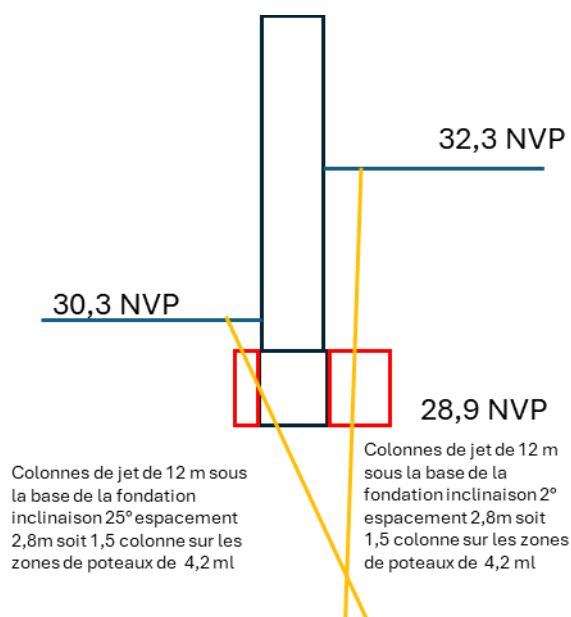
Schéma des tirs des lignes de colonnes de jet de la fondation de la façade contemporaine au droit des zones d'influence des poteaux inclinés 1001 à 1006
